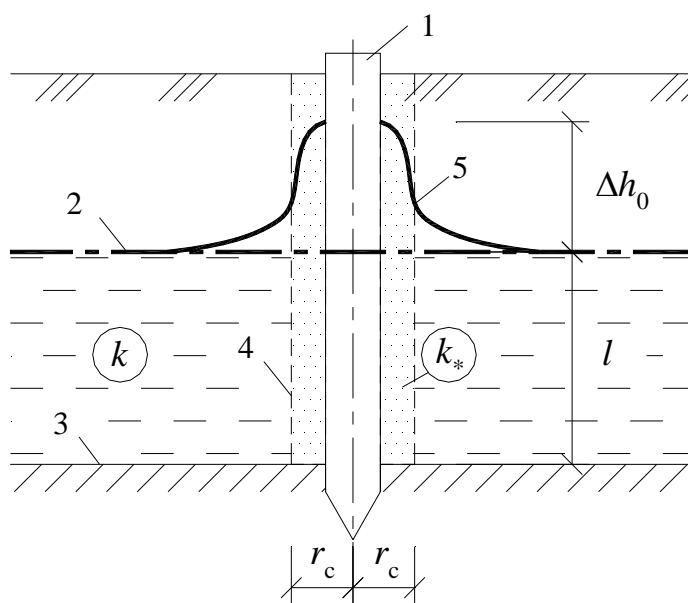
Повышение уровня грунтовых вод (УГВ) при забивке свайного ряда: 1 — свая; 2 — естественный УГВ; 3 — водоупор; 4 — зона максимально уплотненного грунта; 5 — нарушенный УГВ
